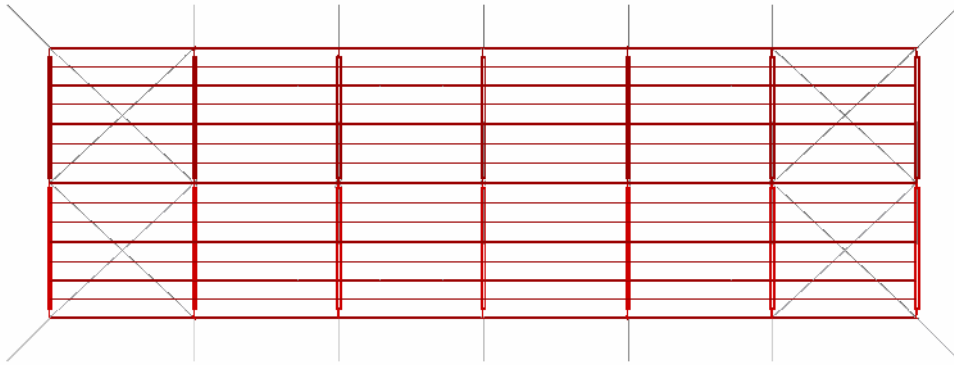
Vista in pianta del sistema di controventi ed ancoraggi al suolo.
